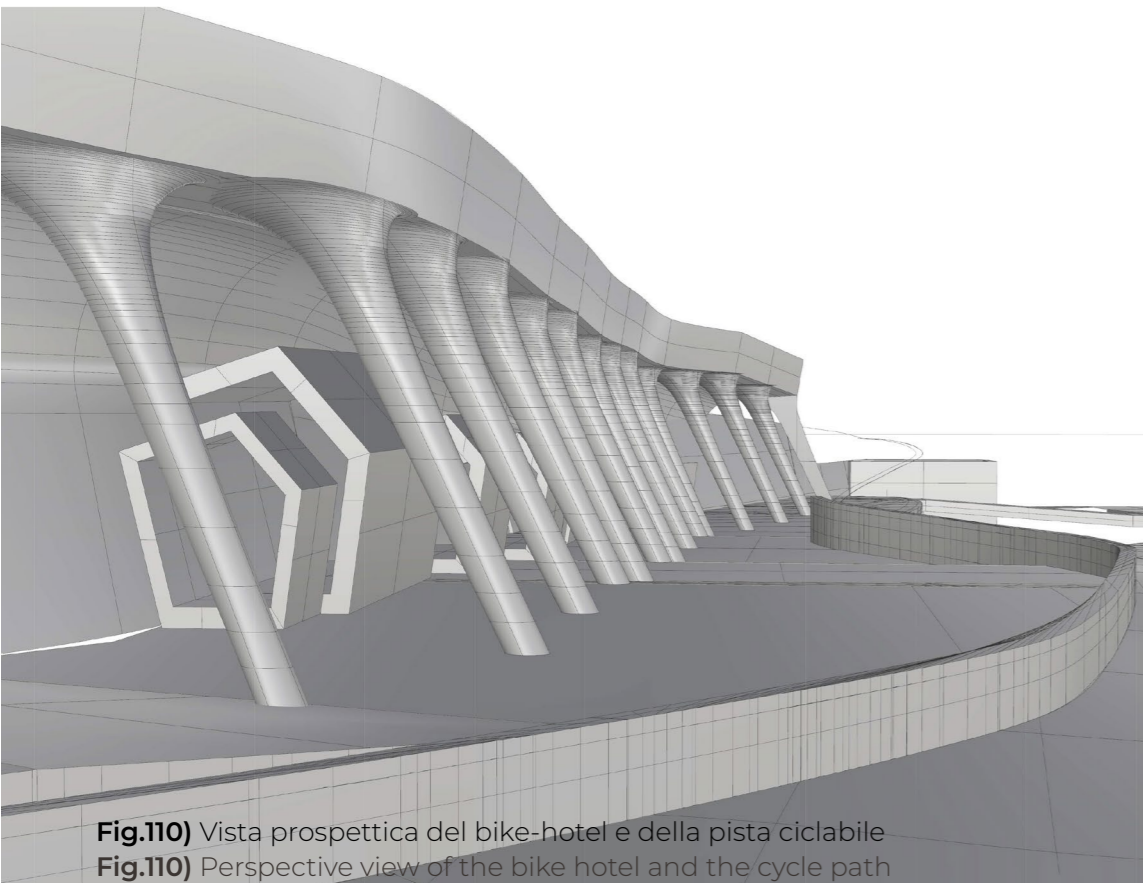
Vista prospettica del bike-hotel e della pista ciclabile
